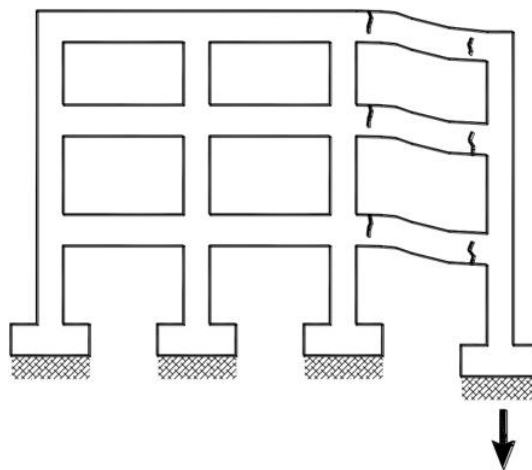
Detalle de fisuración de columna de fachada
